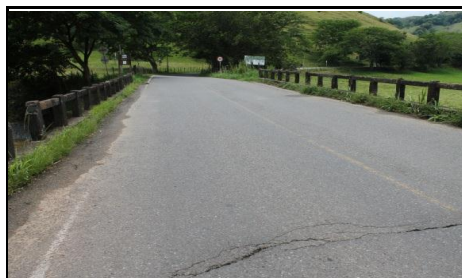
VISTA PANORÁMICA TRANSVERSAL
